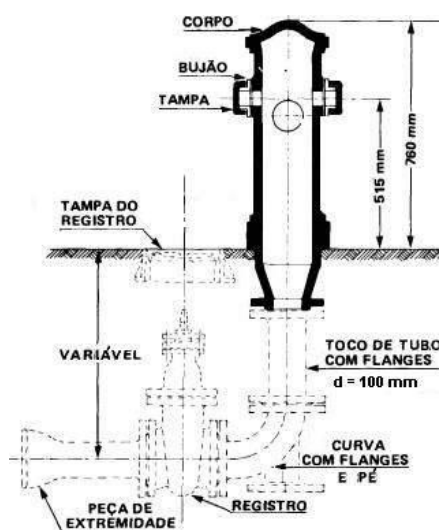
Esquema em corte para instalação de um hidrante de coluna
